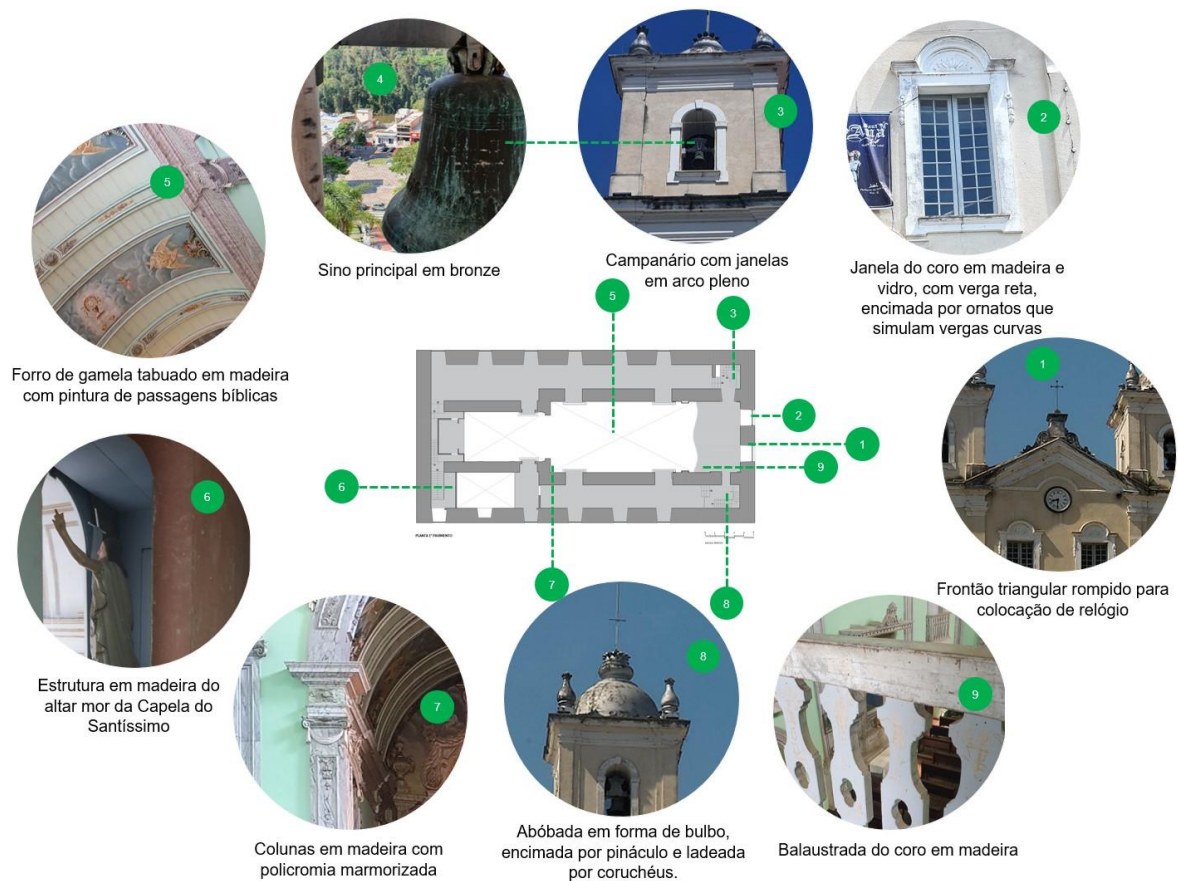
Detalhes construtivos do 1º pavimento da igreja.
